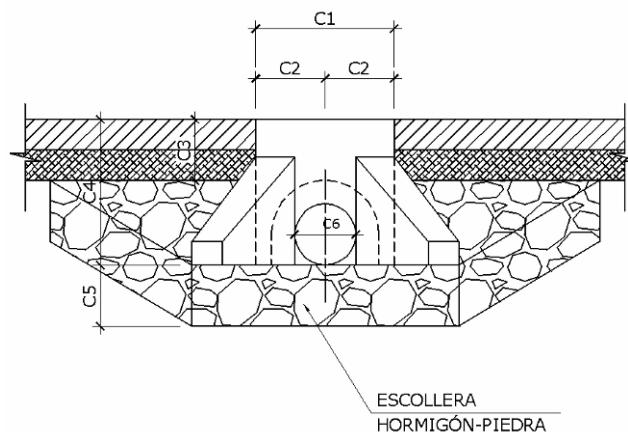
Alzado de ODT en su salida con embocadura de aleta y escollera de piedra.
